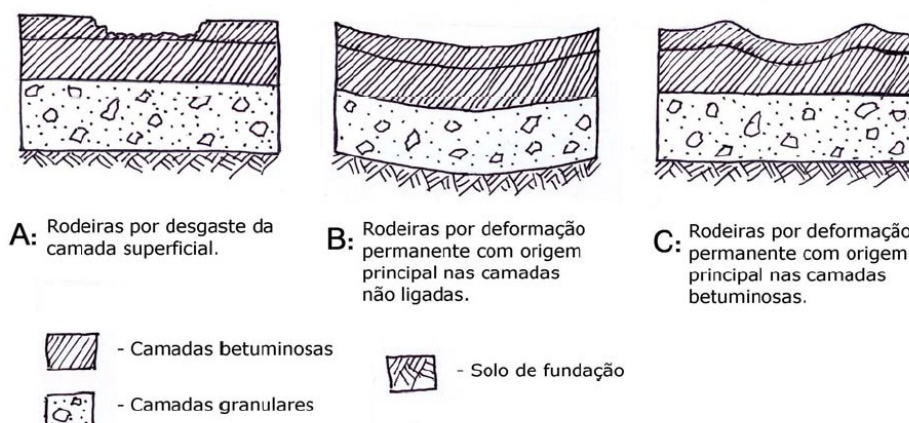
Esquema das deforma es permanentes do pavimento, associadas ao aparecimento de rodeiras (adaptado de Gardete, 2006)
